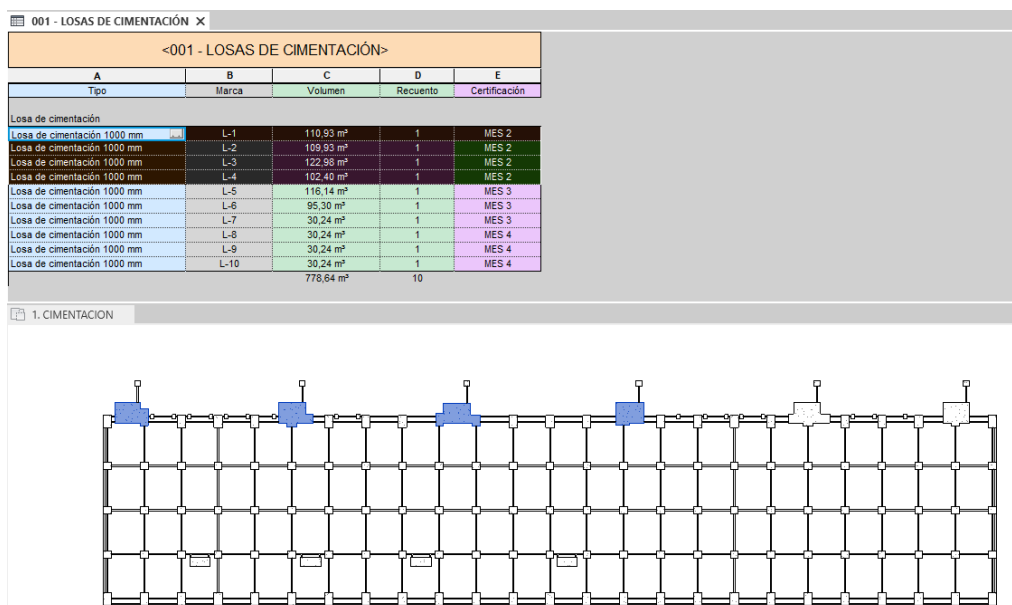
Selección en tabla y vista en plano de planta de las losas certificadas en el mes 2.
